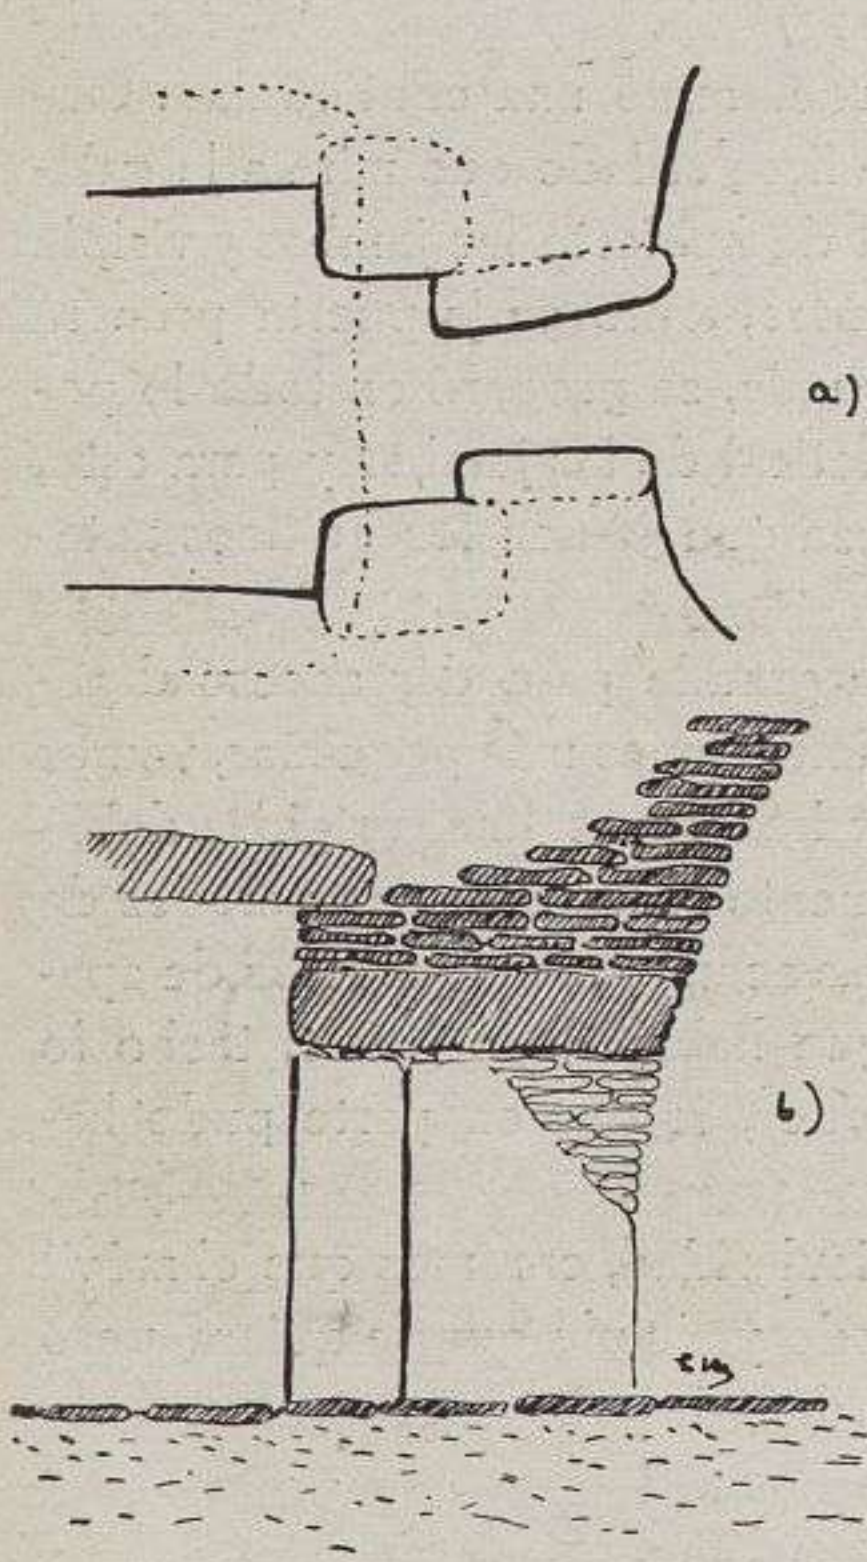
Planta y sección de la primera puerta del Romeral.
